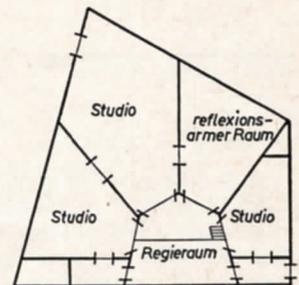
Grundrisse von großen Hörspielstudios, deren Bau nach 1945 beendet wurde
